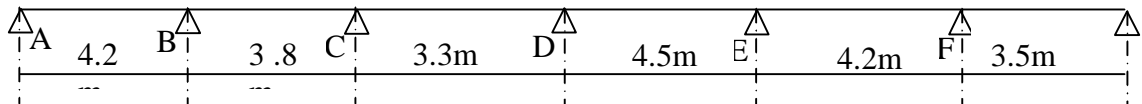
Schéma du 1<sup>ier</sup> type de poutrelles .
